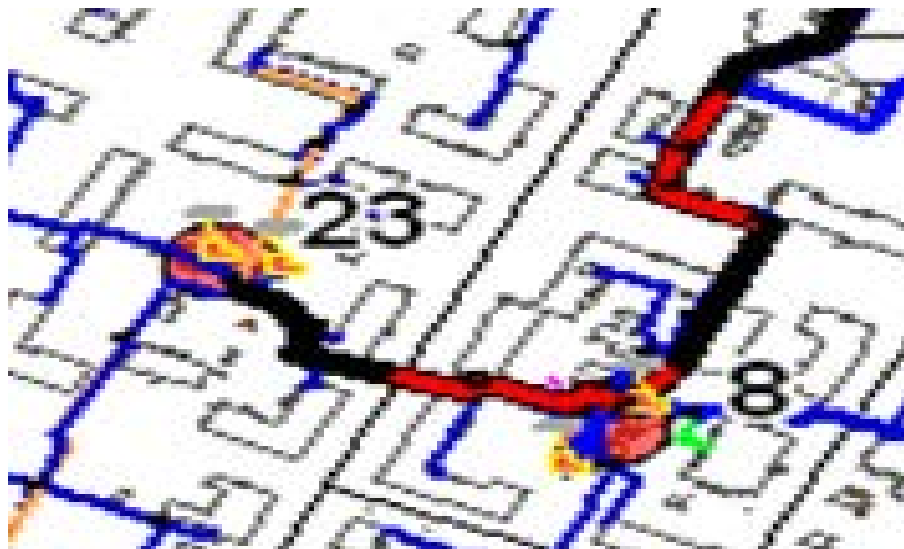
Схема прокладки трубопровода от котельной №8 до котельной №23
